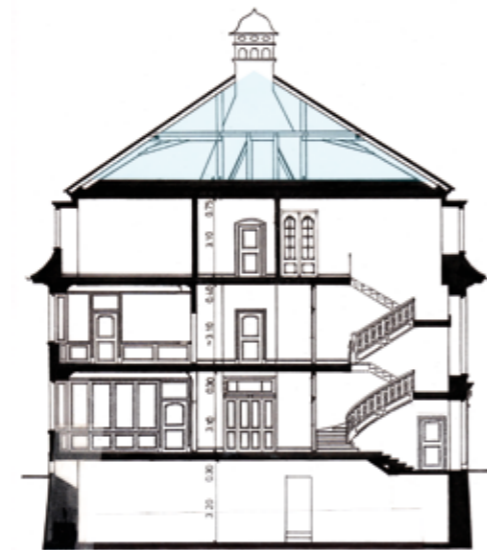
Querschnitt mit Kaltdach (hellblau). Plan: Bürgerhaus im Kanton Aargau, S. 97
